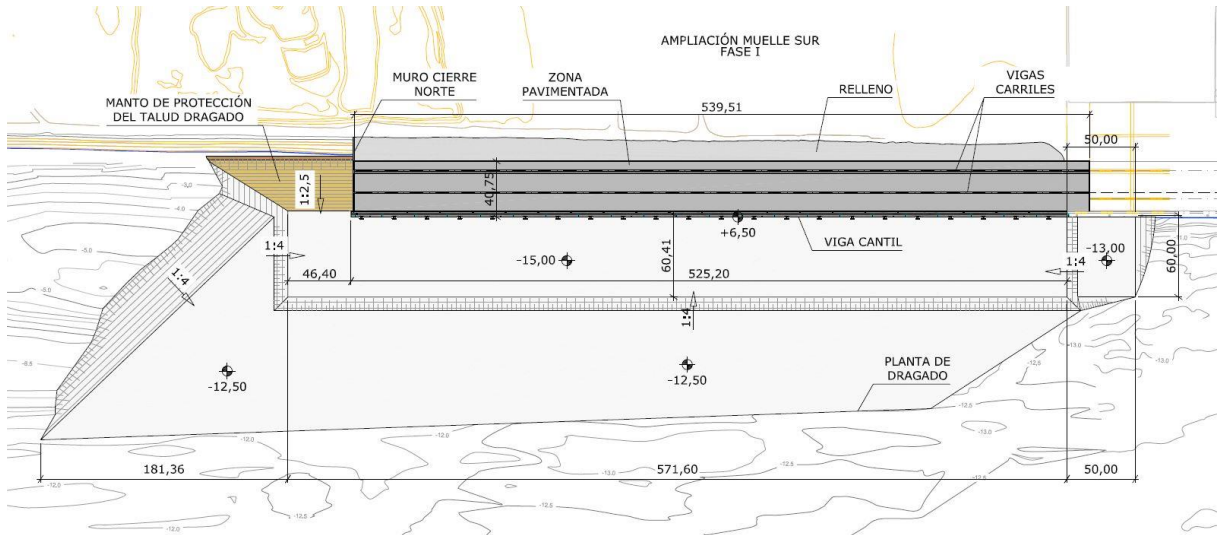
Planta de las obras antes del dragado a la cota -17. No se incluye el dragado de la canal
